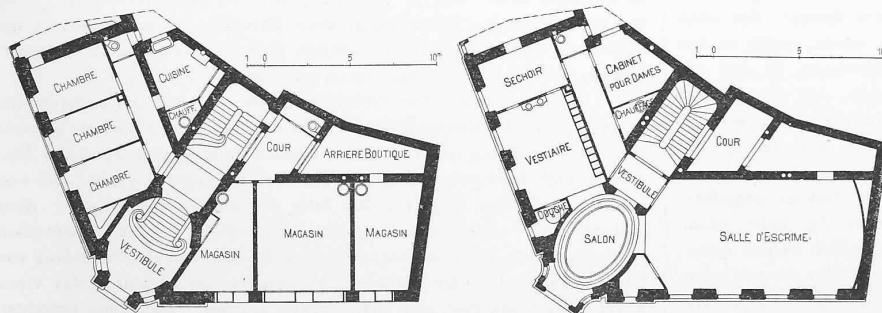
Plan du rez-de-chaussée. -- Echelle 1:400, -- Fig. 23. Plan du premier étage.
